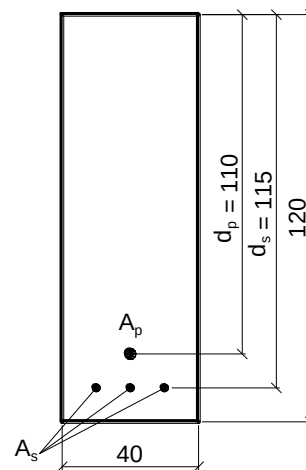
Dimensões (cm) da seção transversal da viga retangular.
